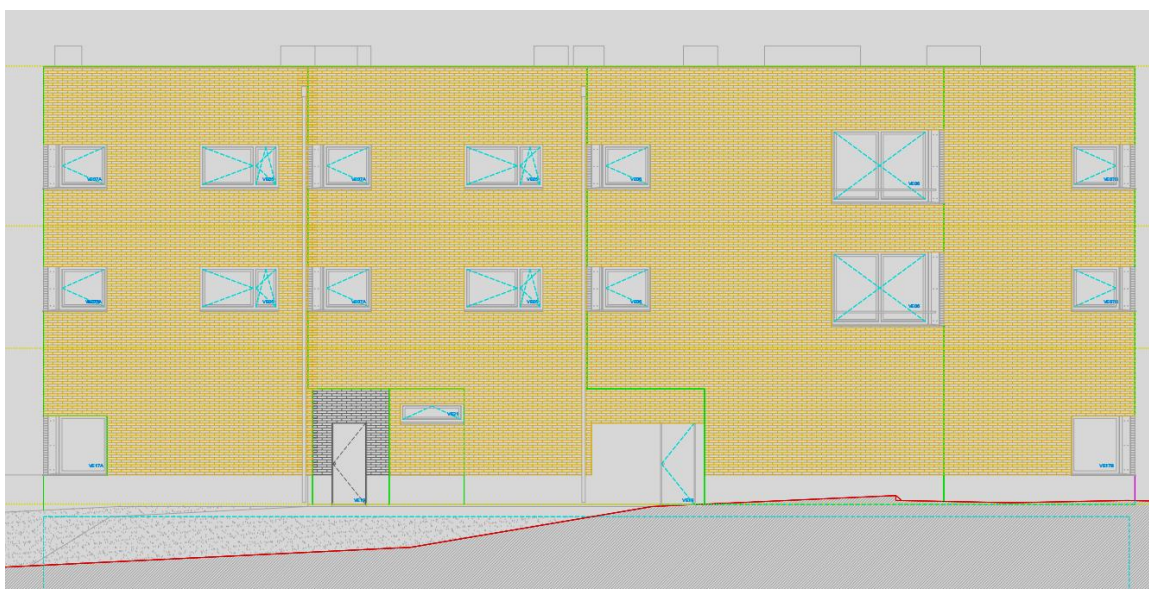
Alçado norte (FONTE: Ficheiro AutoCad – projeto de arquitetura)
